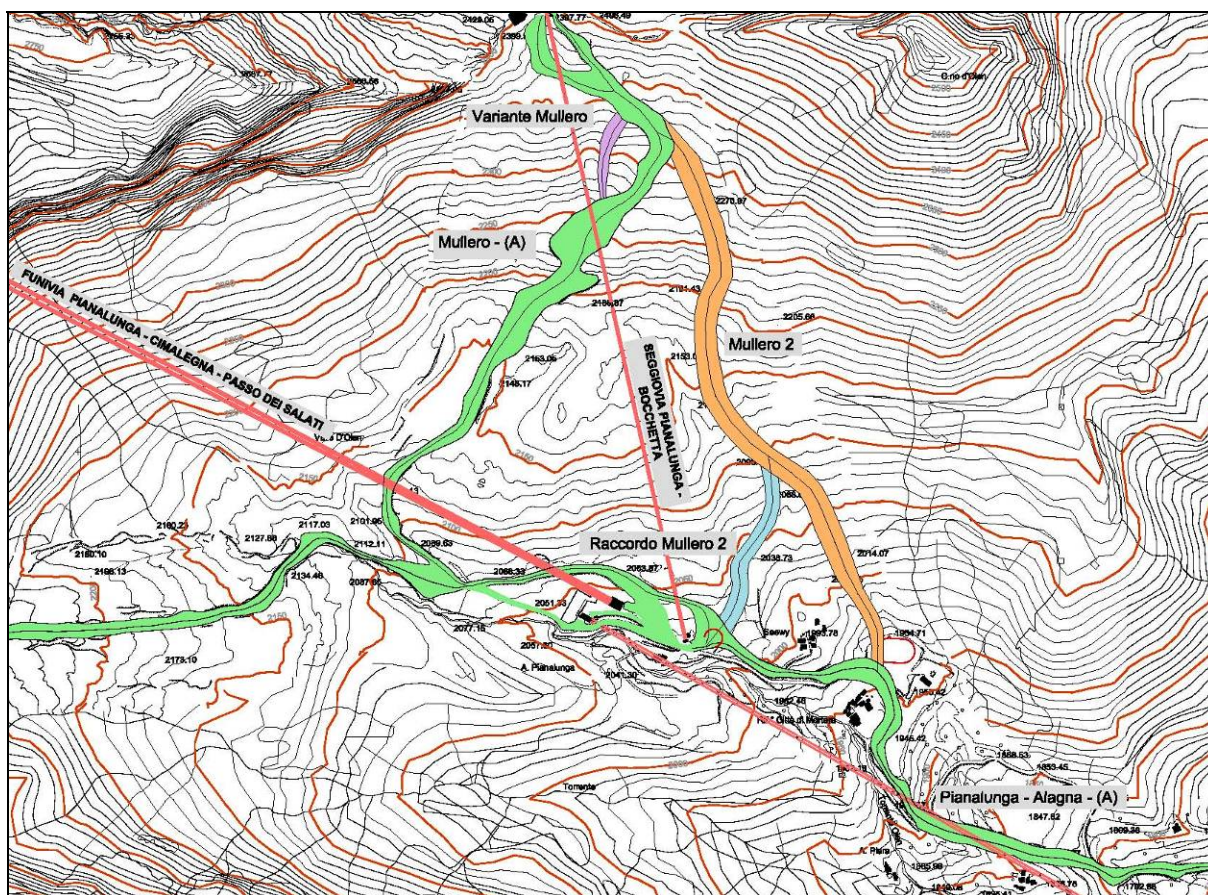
/1 – Localizzazione delle opere in progetto
